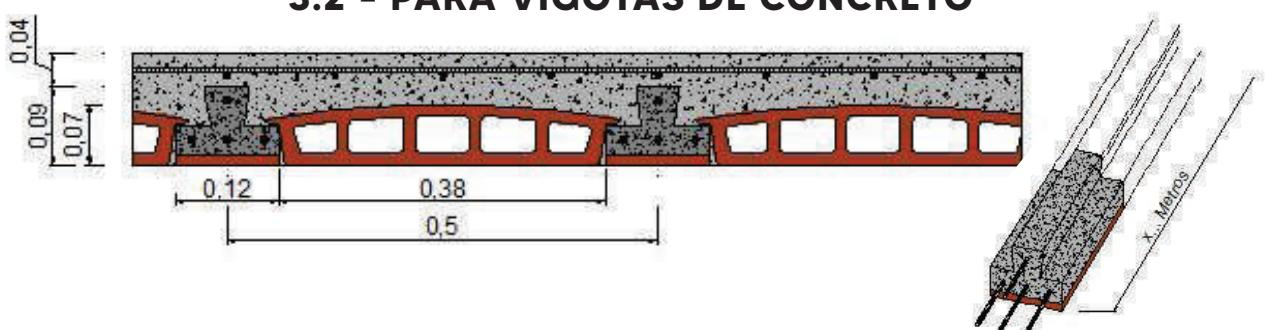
Laje pré-moldada e vigota de concreto. (*-5).
